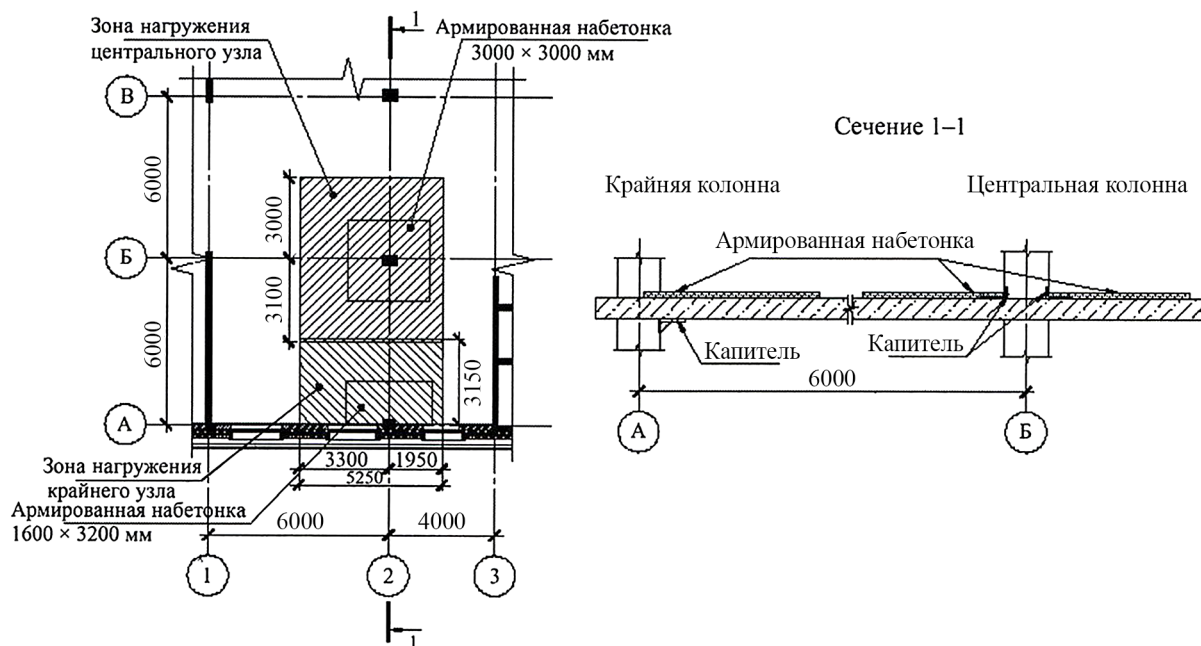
Фрагмент конструкций зданий: план набетонки и схема нагружений
